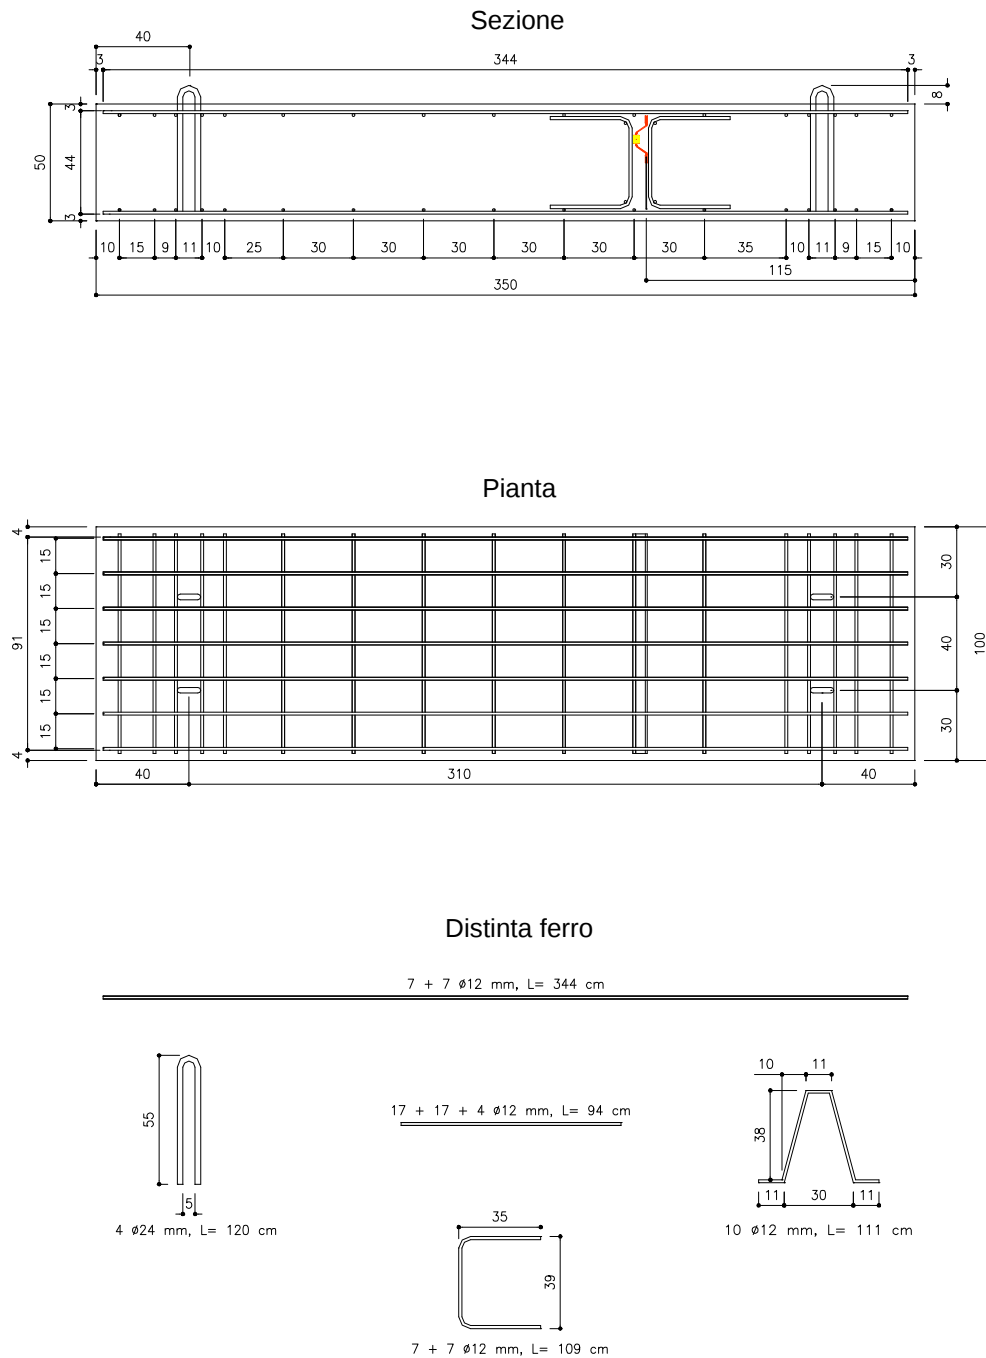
Trave DRY 3: trave con giunto “Drytech” con orientamento sinistro.
